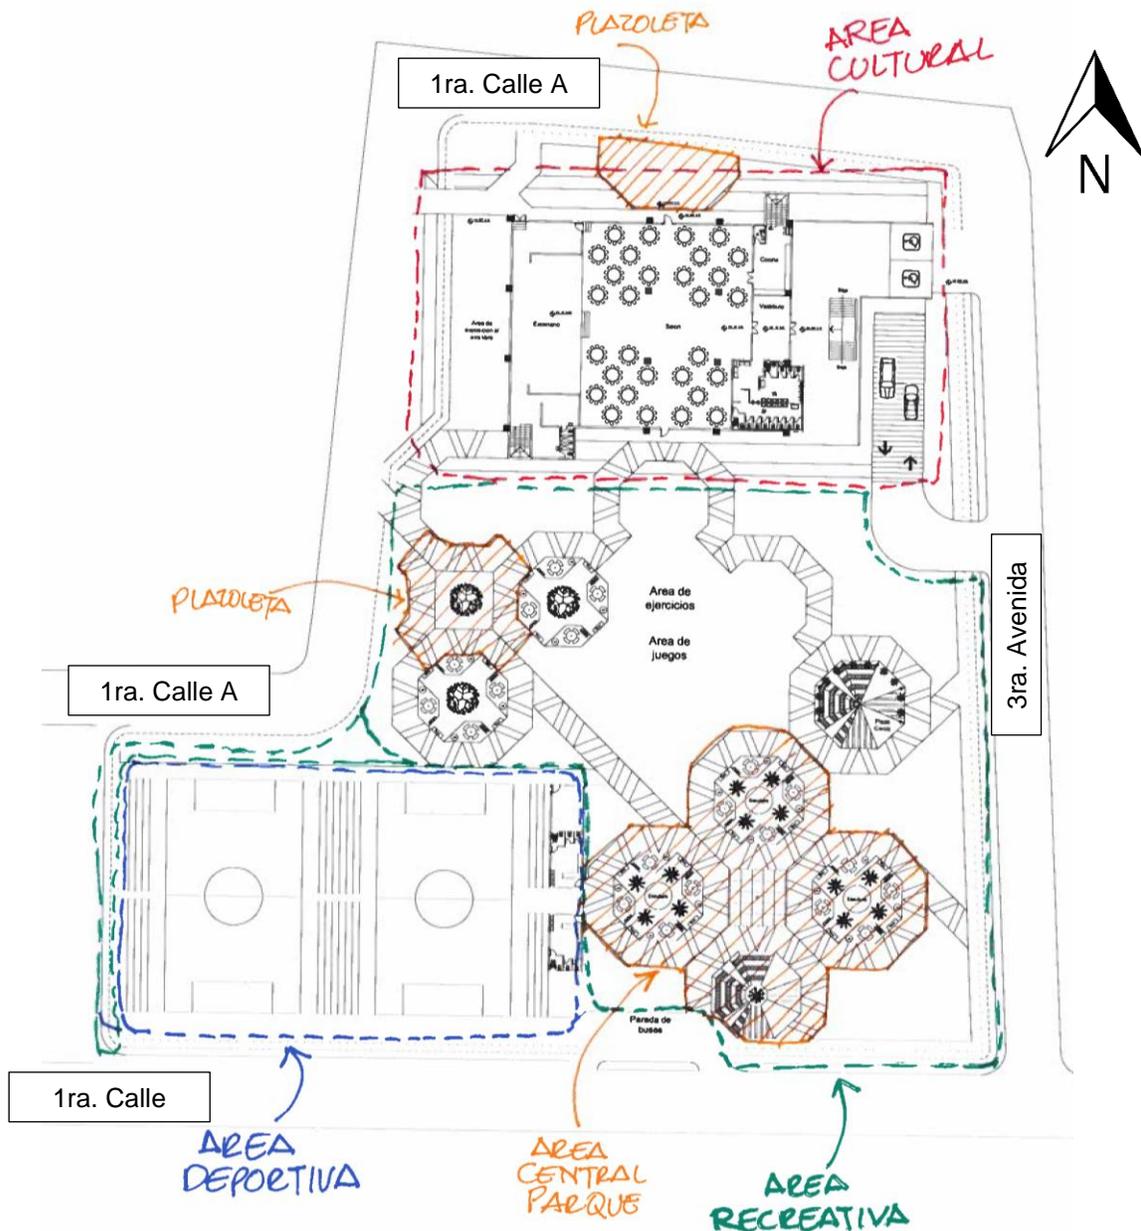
Sectorización de áreas en planta de conjunto, Plano base y esquematización propia, 2021.
